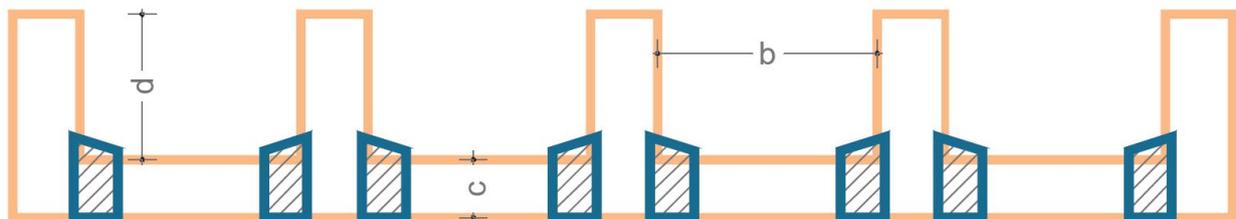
ipotesi della configurazione planimetrica del paramento murario a contrafforti.
